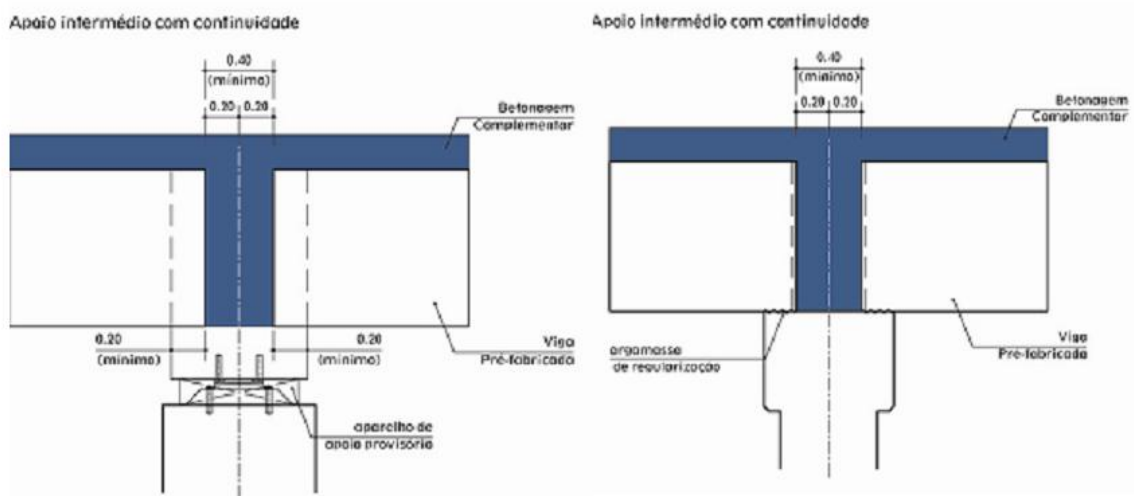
Ligações típicas pilar-viga (VIEGAS & SARAIVA, 2010).
